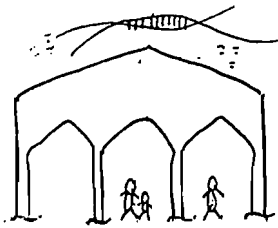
Tonjolan batu yang membentuk hirarki ruang
